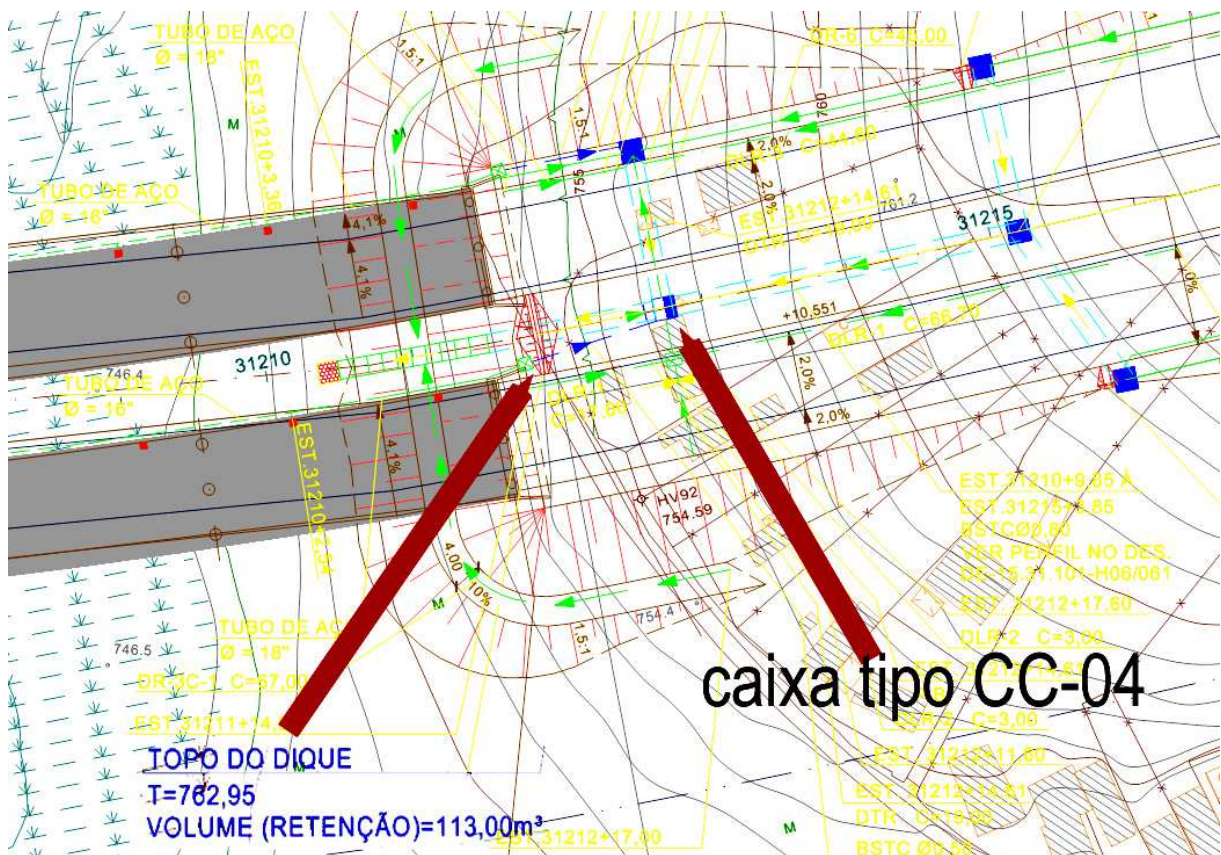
Detalhe sobre a implantação de caixa do tipo CC-04 –Planta. Observe o dique, o volume e a posição no canteiro central.
